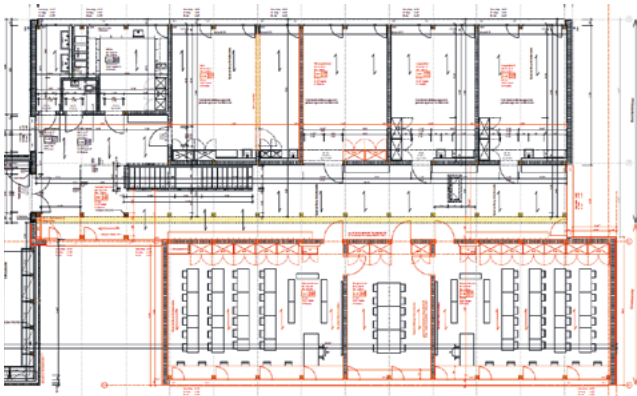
Grundriss Obergeschoss (Planstand TU-Ausschreibung)
